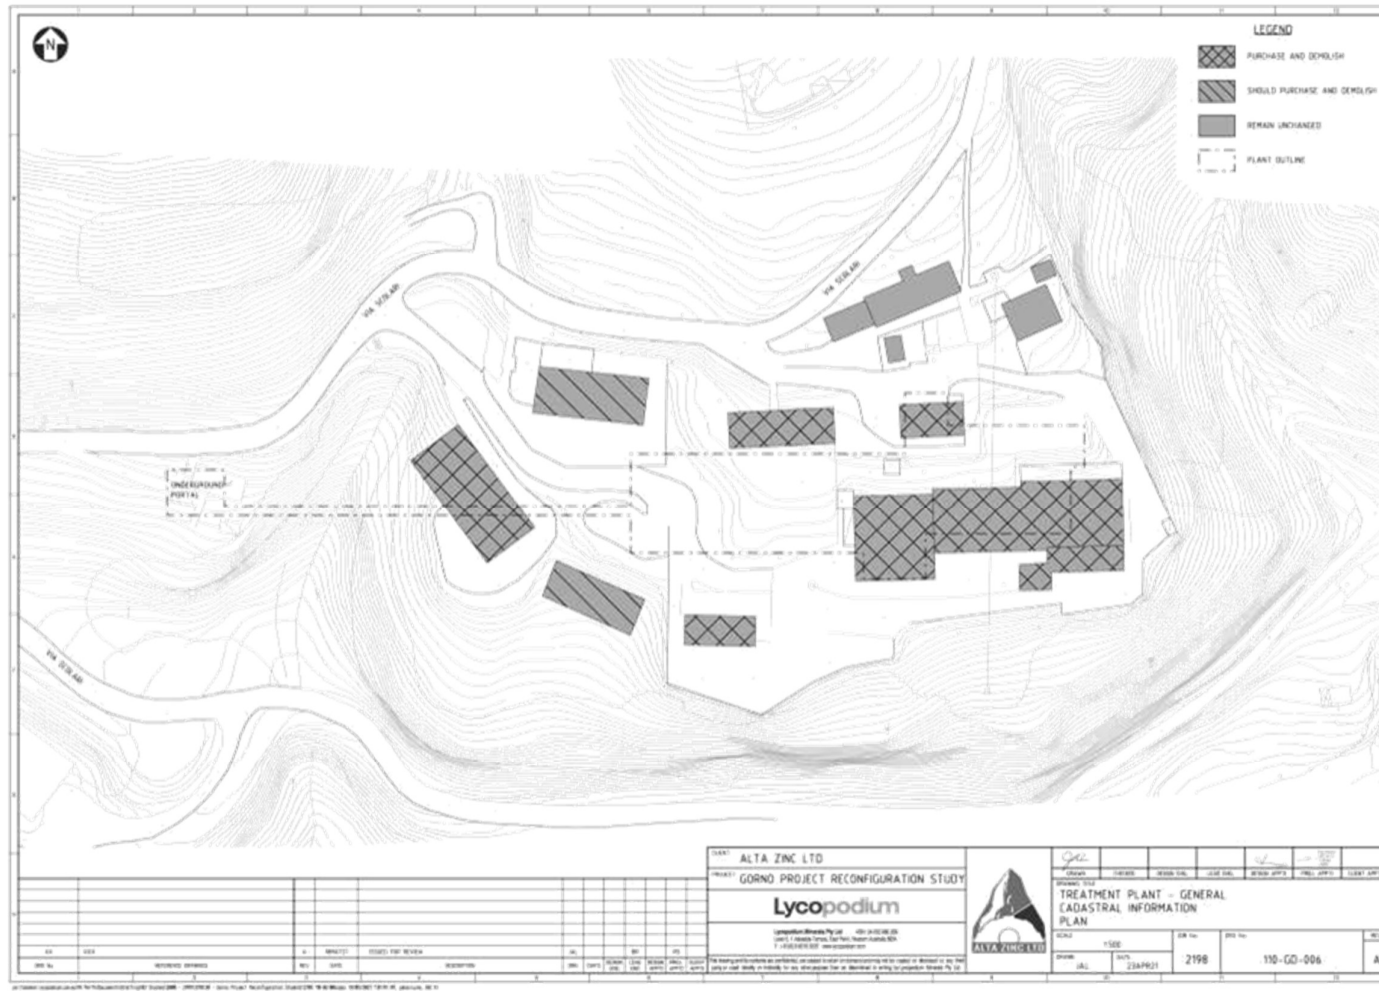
Layout del sito di Zorzone (edifici attuali con sfondo grigio scuro)
